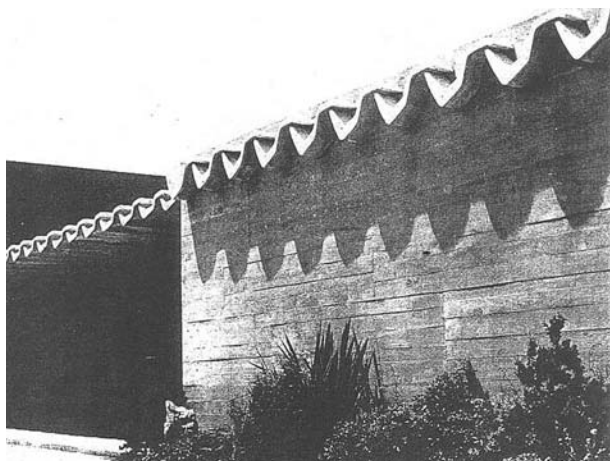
Aplicación de piezas huecas a cubiertas y forjados.
